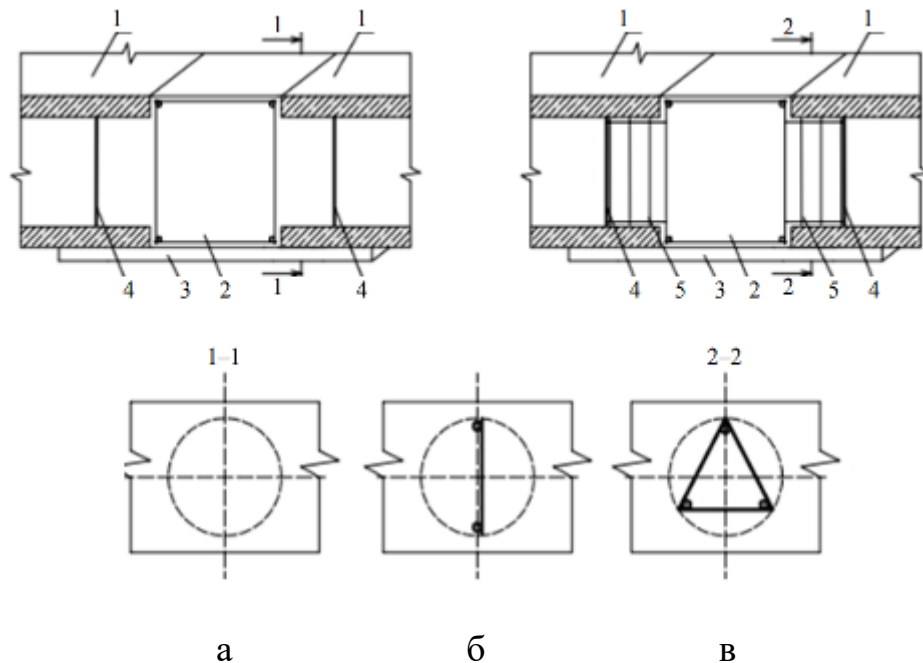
Вузол обпирання багатопустотних плит на монолітний залізобетонний ригель збірно-монолітного перекриття шляхом бетонних шпонок (а), армованих плоскими (б) і просторовими (в) каркасами у вигляді порожньої призми з трикутною основою:
